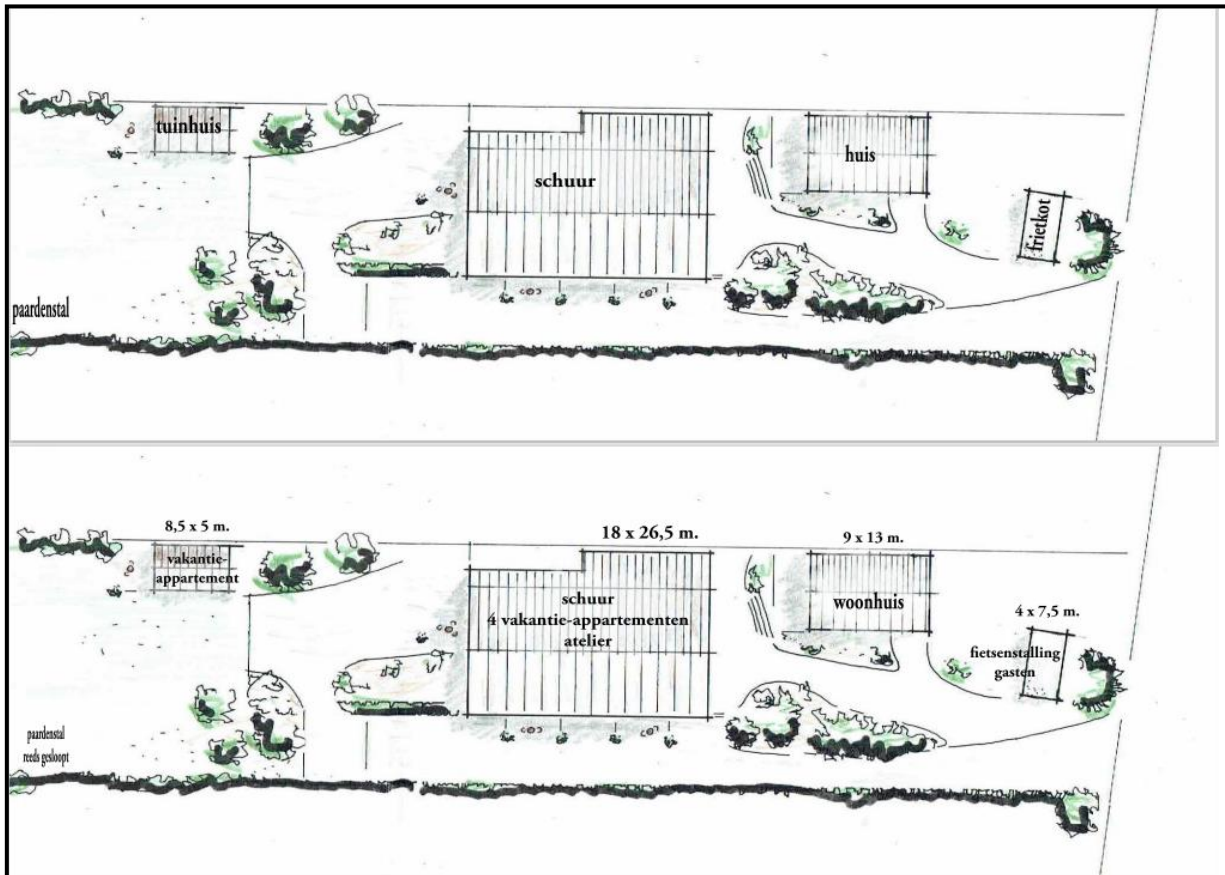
Verbeelding plangebied volgens vigerend bestemmingsplan
